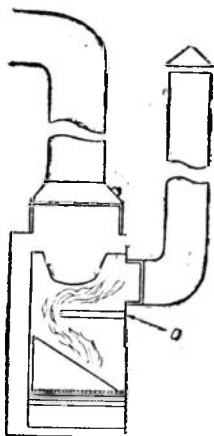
Топочная коробка печей образца «СП-41» и «СП-42» — с неподвижным огнеотбойным отражателем (а).
